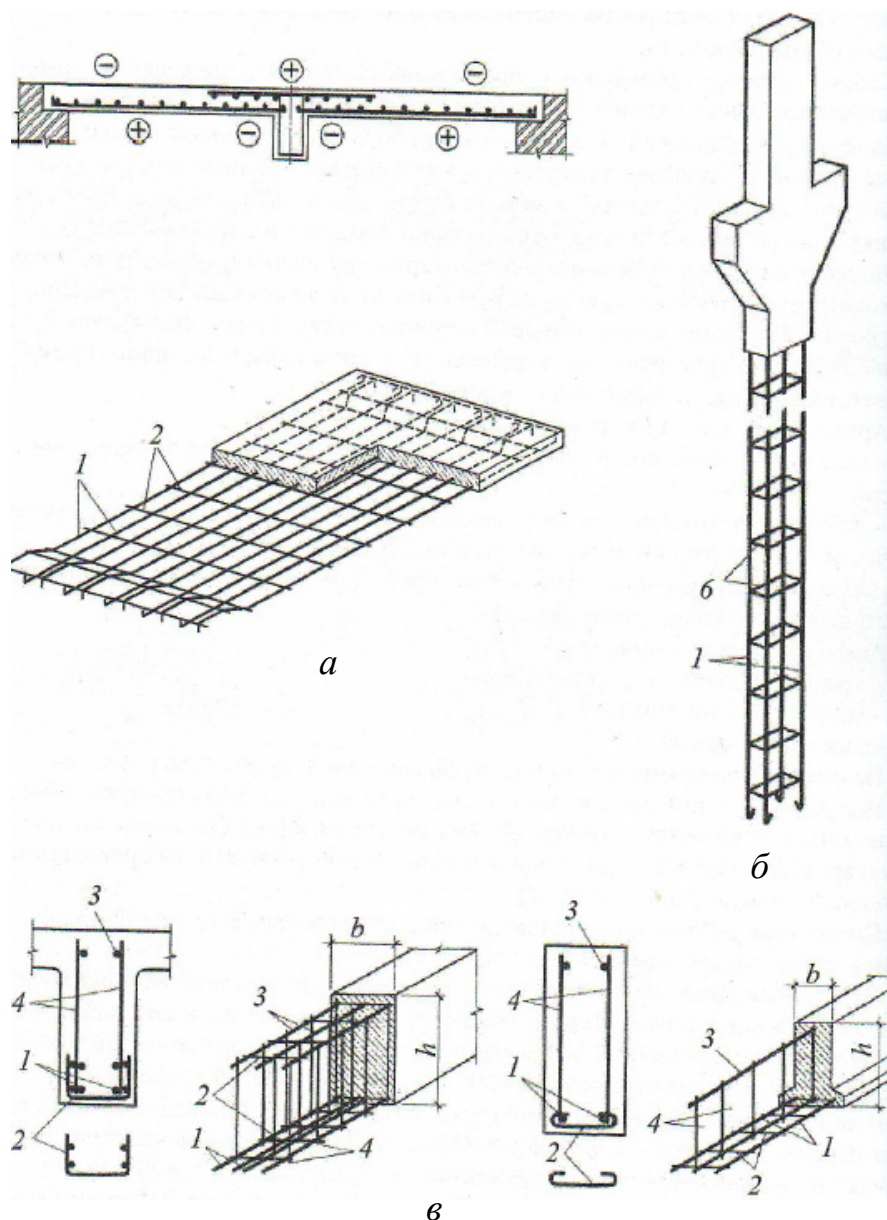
Примеры армирования железобетонных конструкций: *а* – плиты; *б* – колонны; *в* – балки; *1* – рабочая арматура; *2* – конструктивная; *3* – монтажная; *4* – поперечные стержни балок; *5* – конструктивная продольная арматура; *6* – хомуты
